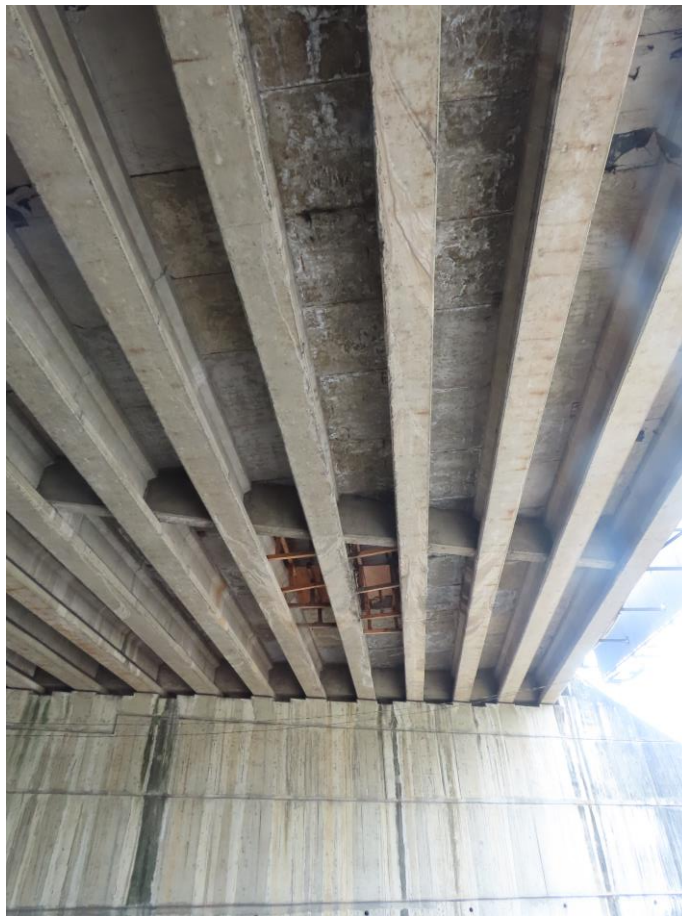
Estado de Losetas Prefabricadas en Carriles Vía El Dorado
